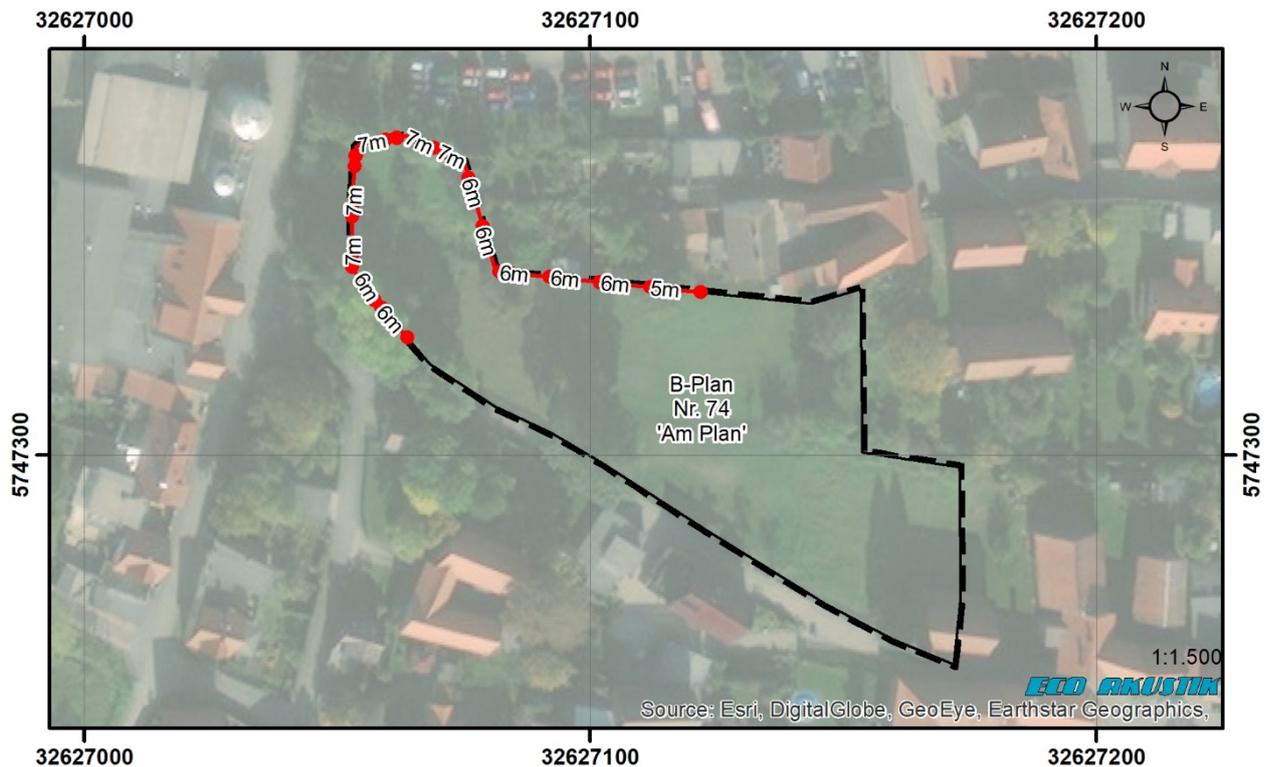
Lage der Lärmschutzwand (rot) inkl. Angabe der Elementhöhe (jedes Element ist 10 m breit)
